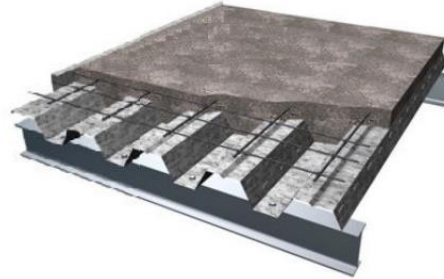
Losa de forjado colaborante “Haircol 59” de la firma Europerfil
